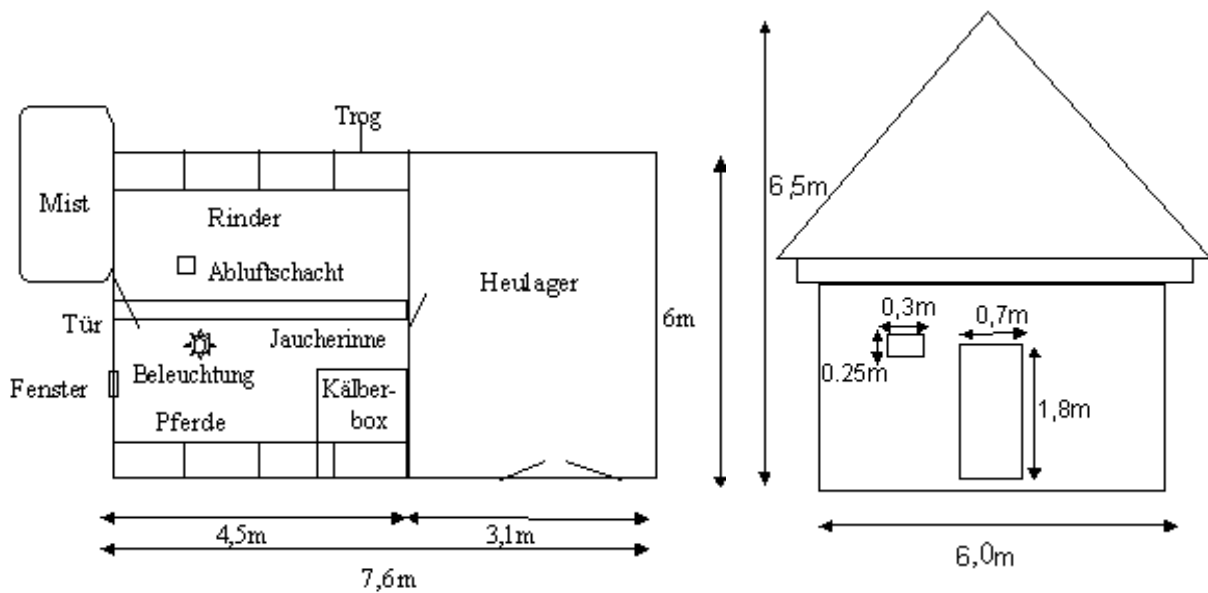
Grundriss und Aufriss (Frontseite) eines 2-teiligen Rinder-/Pferdestalls
